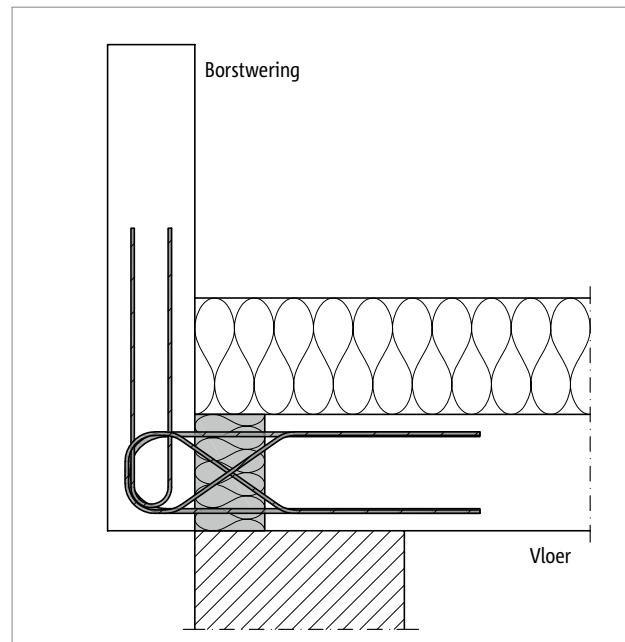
Schöck Isokorf® T type A: Aansluiting van een borstwering (type A-MM2-VV1)
